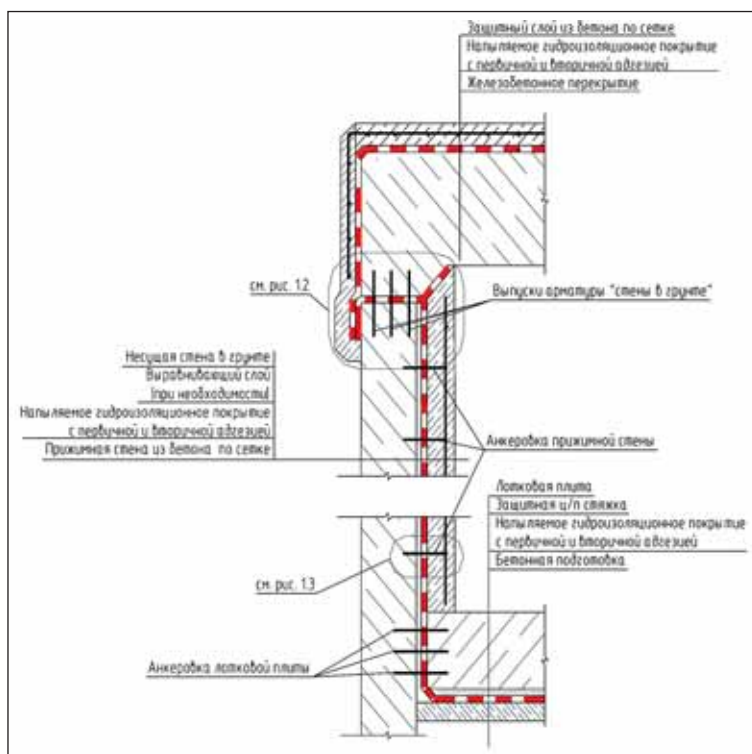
Схема устройства гидроизоляционной системы при открытом способе работ с использованием «стены в грунте» в качестве несущей [11]
